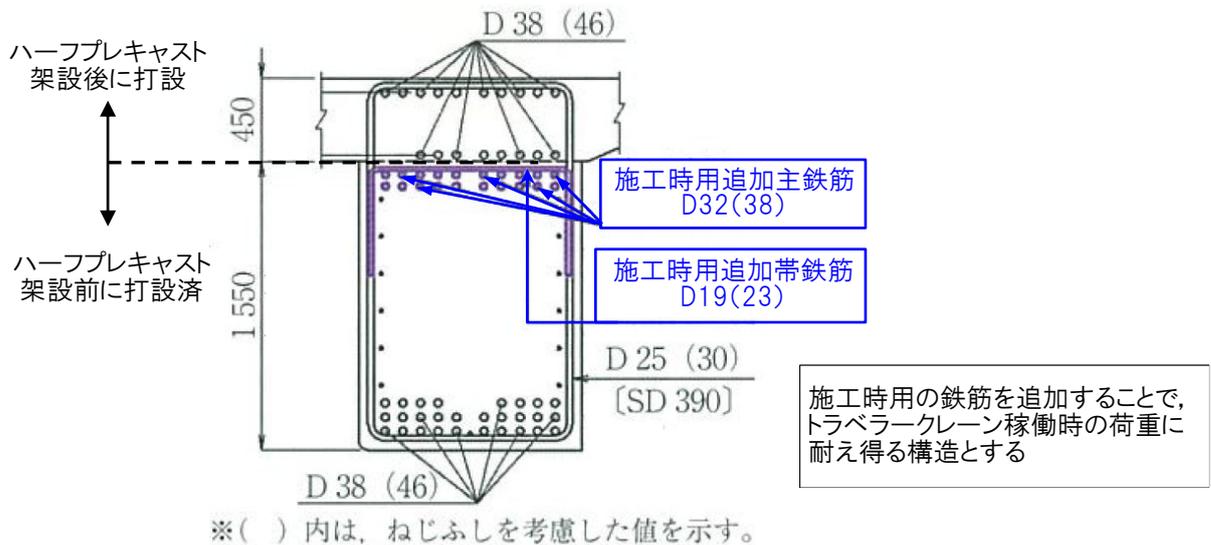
施工時(トラベラークレーン稼働時)を考慮した追加鉄筋
